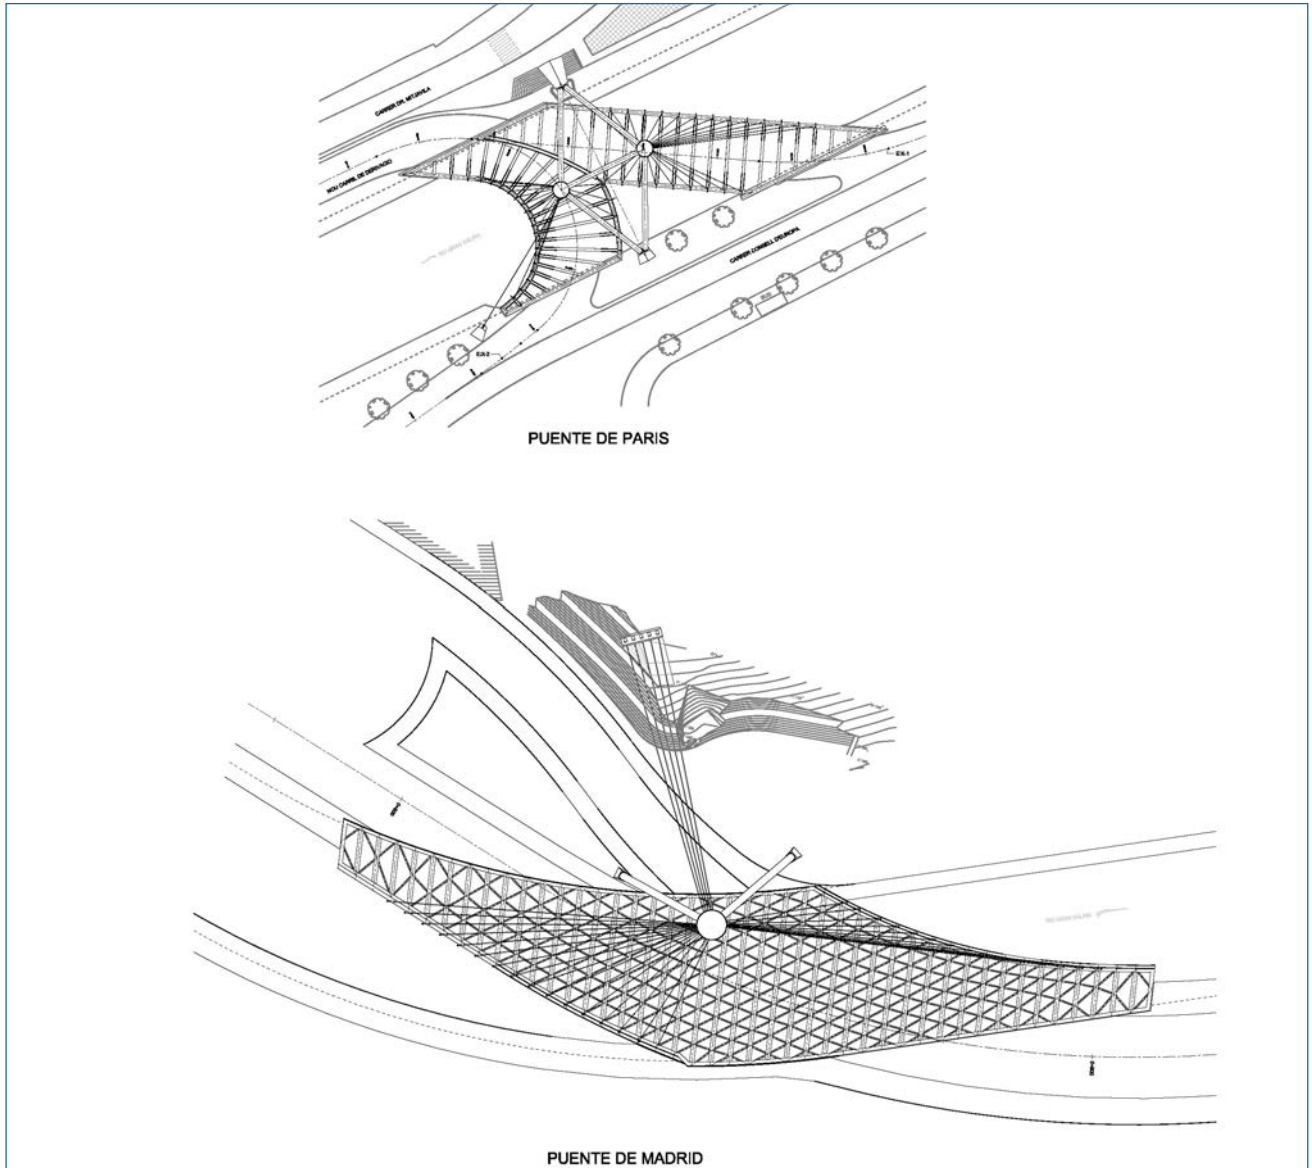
Plantas de las estructuras de los puentes de París y de Madrid.
